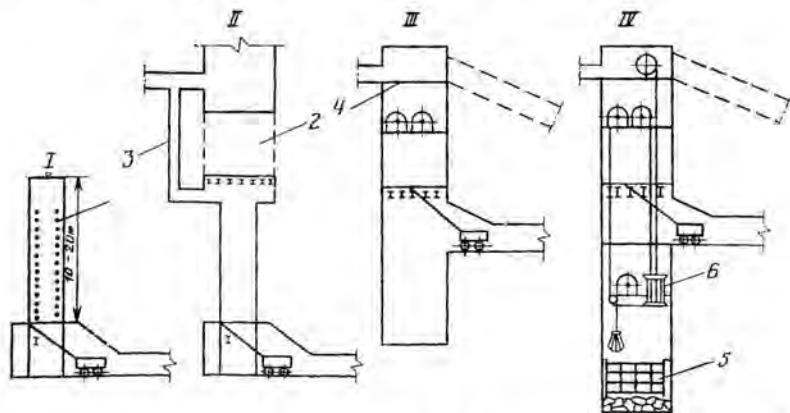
Схема проходки копровой части углубляемого ствола по фазам I-IV: 1 — восстающая; 2 — породный целик; 3 — вентиляционная сбойка (скважина); 4 — подшкивная площадка; 5 — опалубка; 6 — подвесной полк
